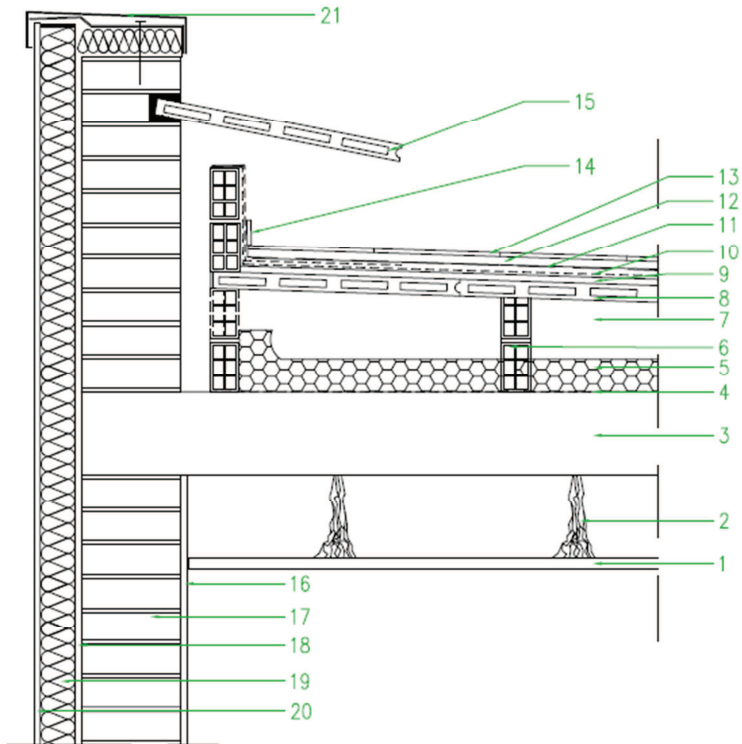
Detalle encuentro cubierta- fachada aislamiento por el exterior
